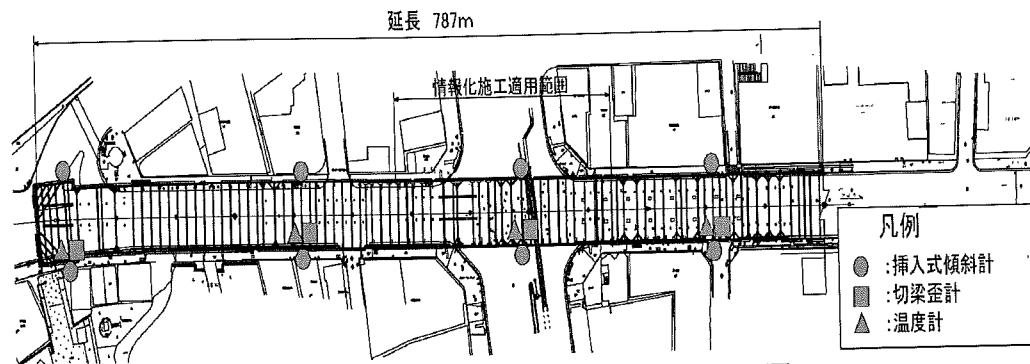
地下鉄13号線新宿三丁目駅計測機器配置平面図
